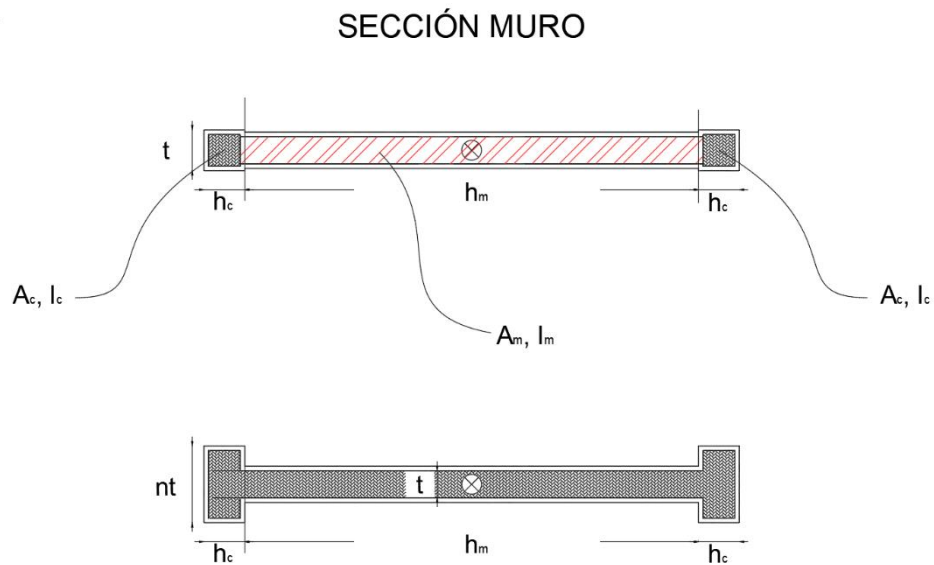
Sección transversal transformada equivalente del muro de mampostería confinada.
